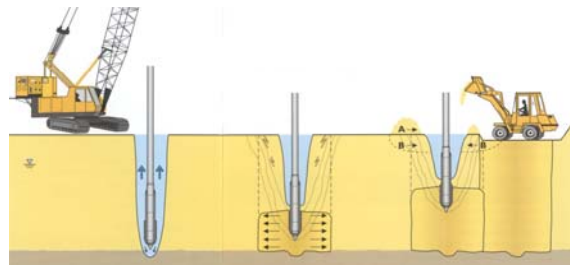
Rütteldruckverdichtung zur Baugrundverbesserung (aus Firmenprospekt KELLER Grundbau GmbH)
